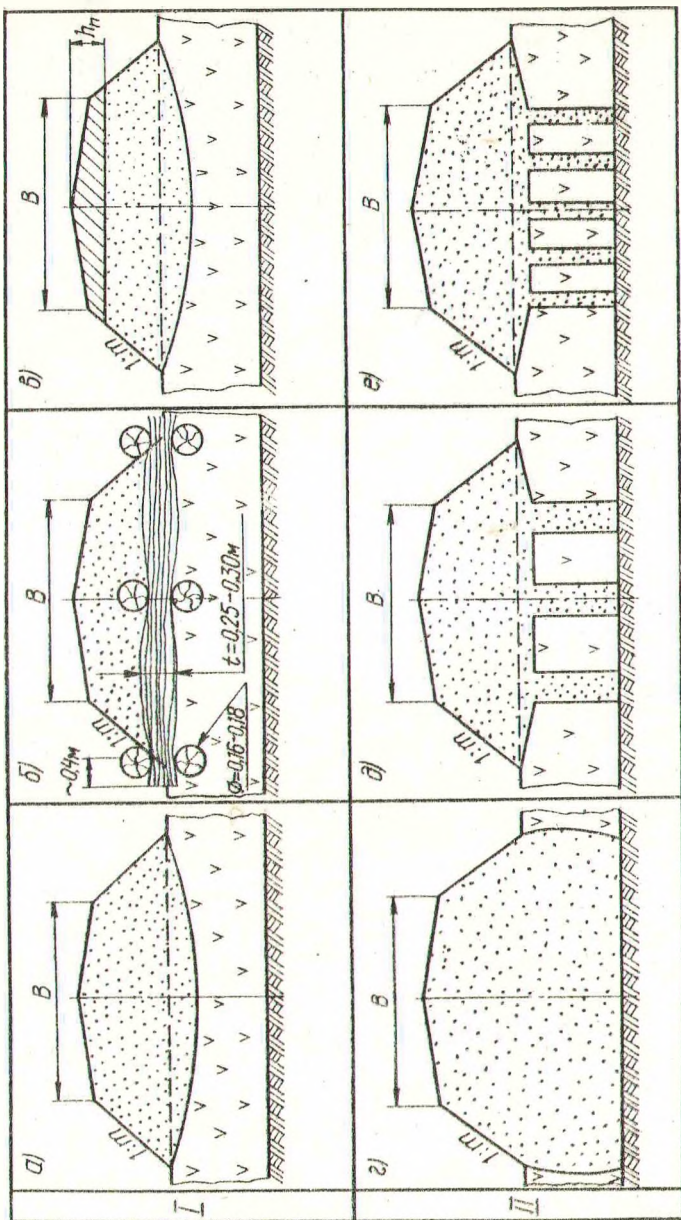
Поперечные профили земляноты полотна лесозонных автомобильных дорог на переходах через болота: I - насыпь, возведенная непосредственно на болоте (а) - шлаковая насыпь, б) - насыпь на хворостяной выстилке, в) - насыпь с временной пригрузкой; II - насыпь, возведенная на жестком основании (г) - насыпь на минеральном дне, д) - насыпь на продольных разрезах, е) - насыпь на сваях
